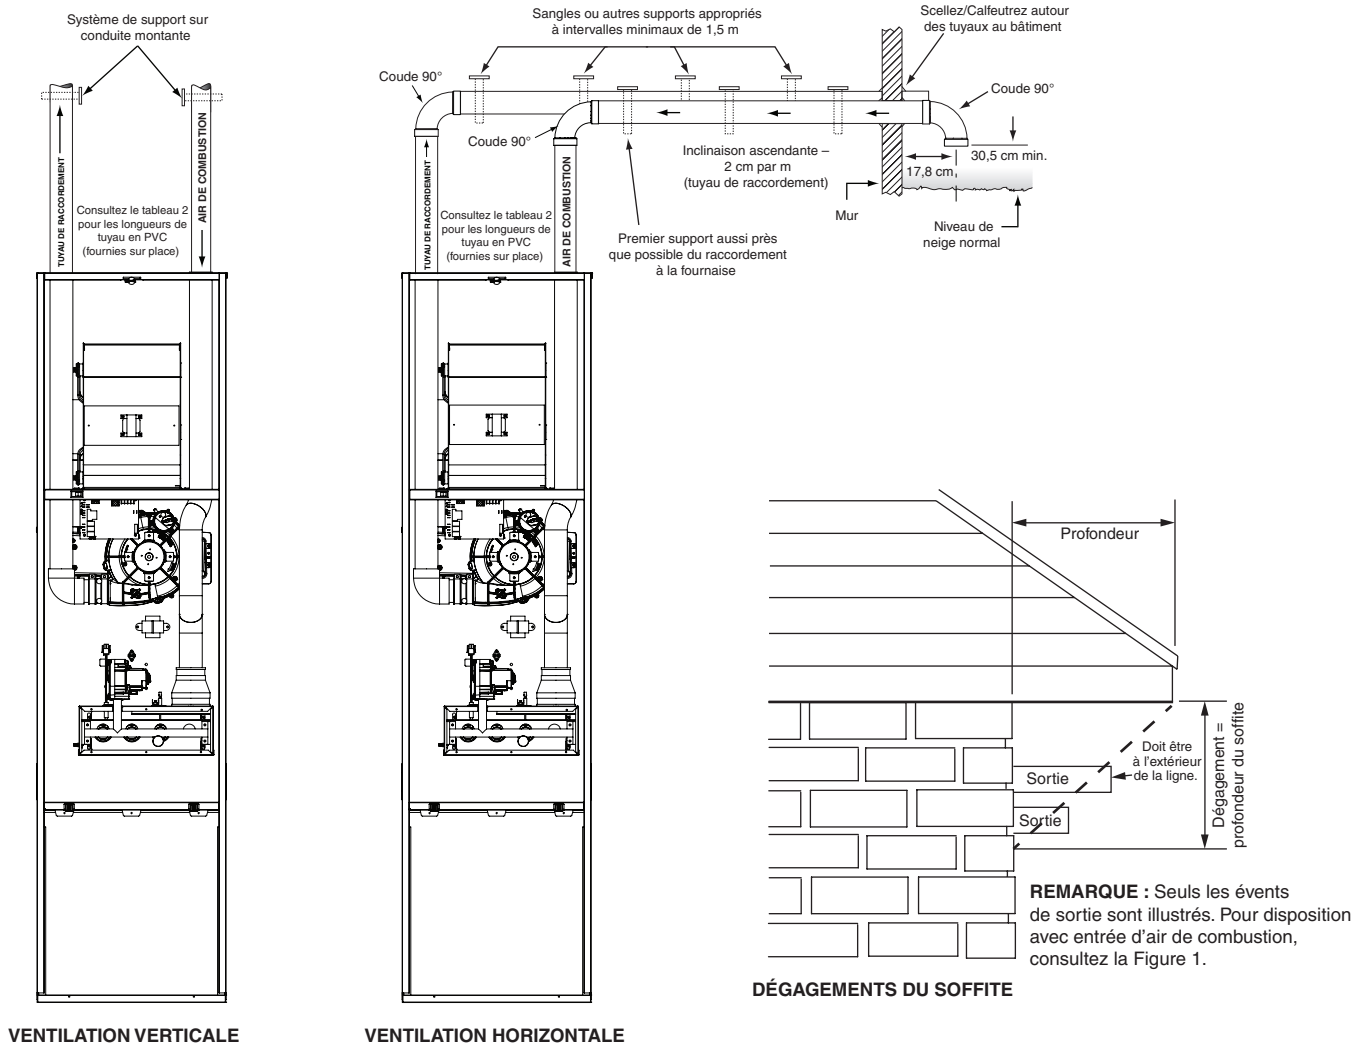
Évacuation horizontale/verticale et dégagements du soffite
